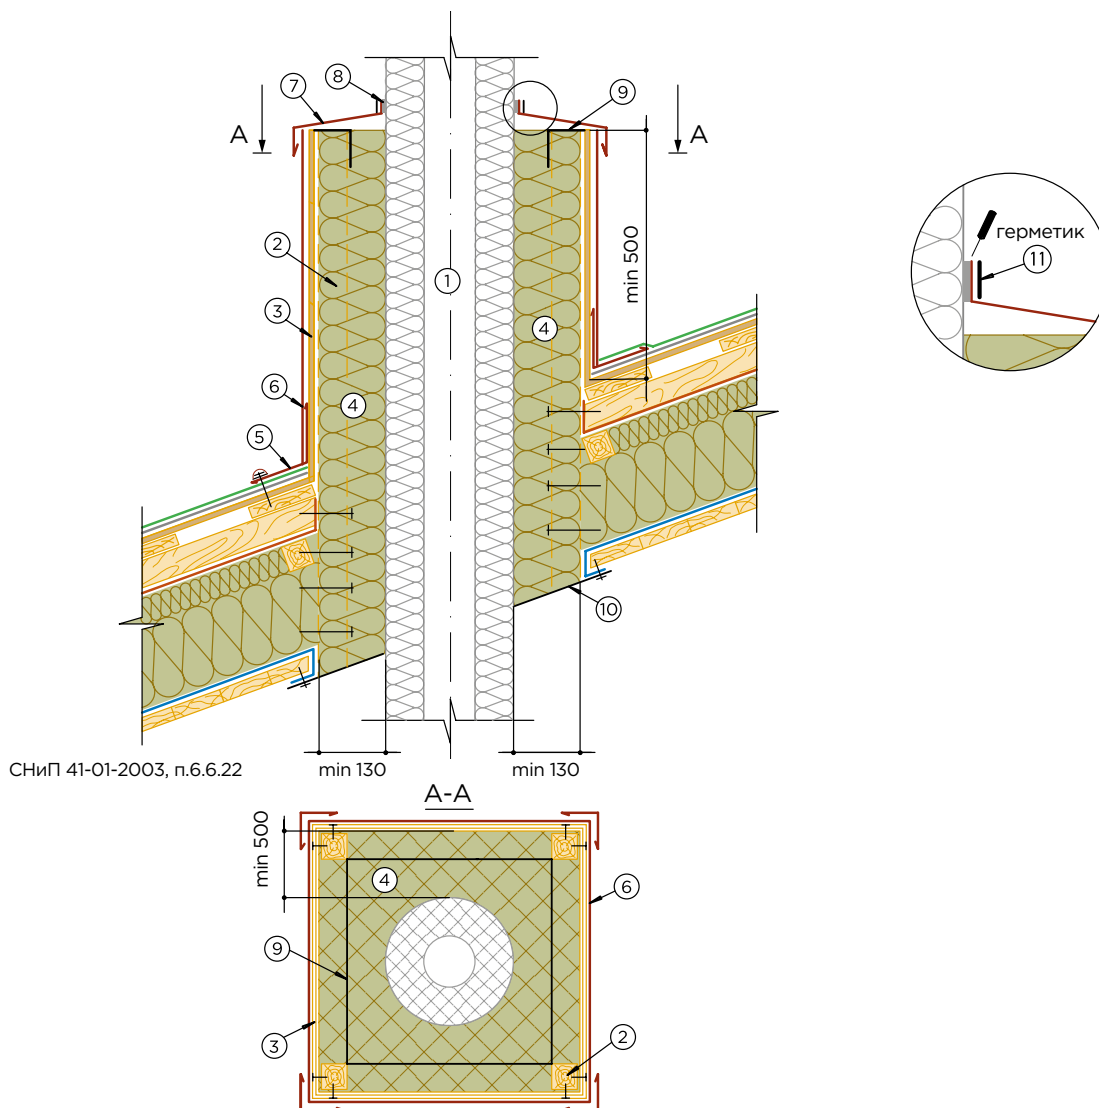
Вариант примыкания кровли мансарды к трубе типа «сэндвич»
